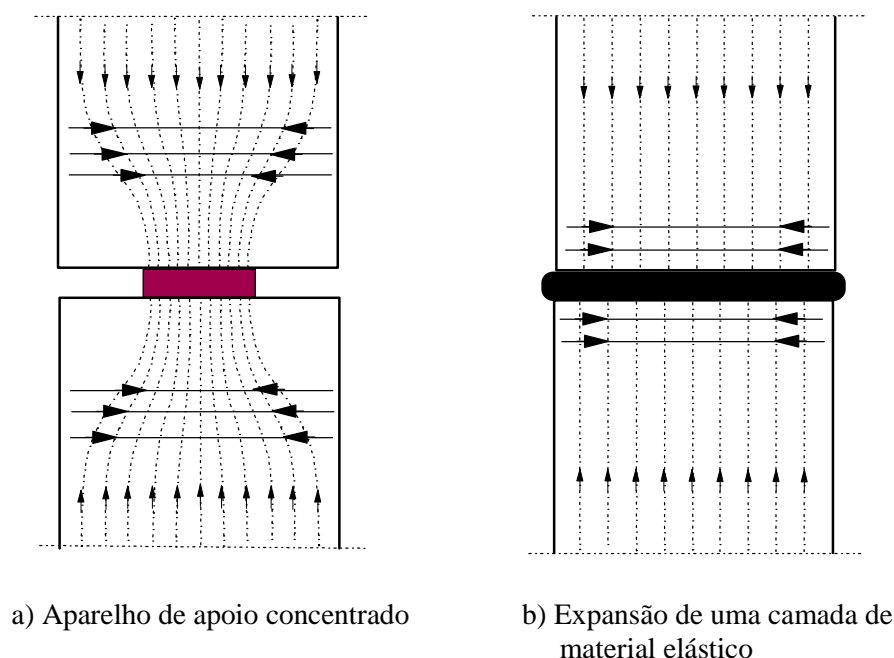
Tensões de tracção transversais em ligações em compressão
